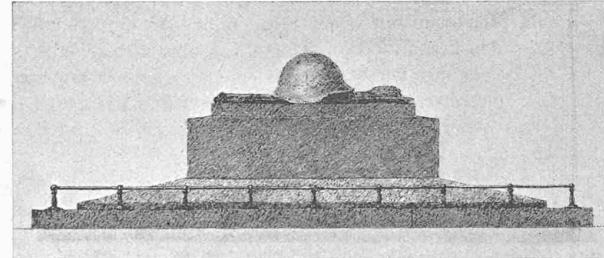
und 6. Grundriss und Aufriss. — Maßstab 1:50.
